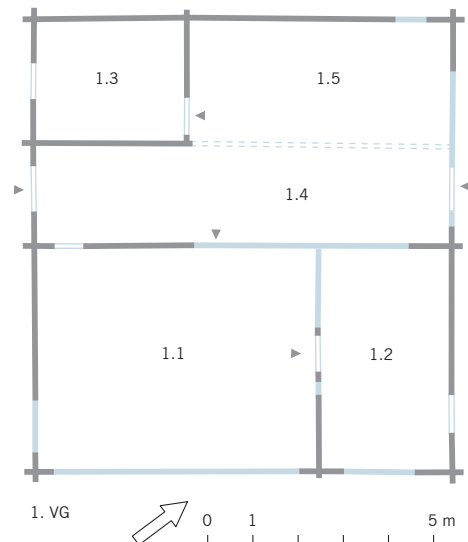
Haus Unterblacki in Unterägeri, Grundriss des ersten Vollgeschosses.
